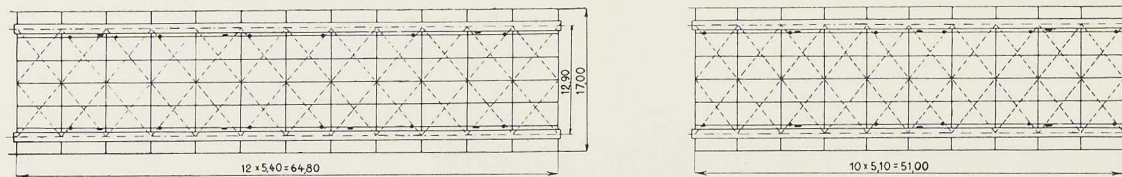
Vue en plan des deux ponts, montrant la disposition du contreventement inférieur. Les deux ponts sont réunis par un ponceau à poutre droite en béton.
